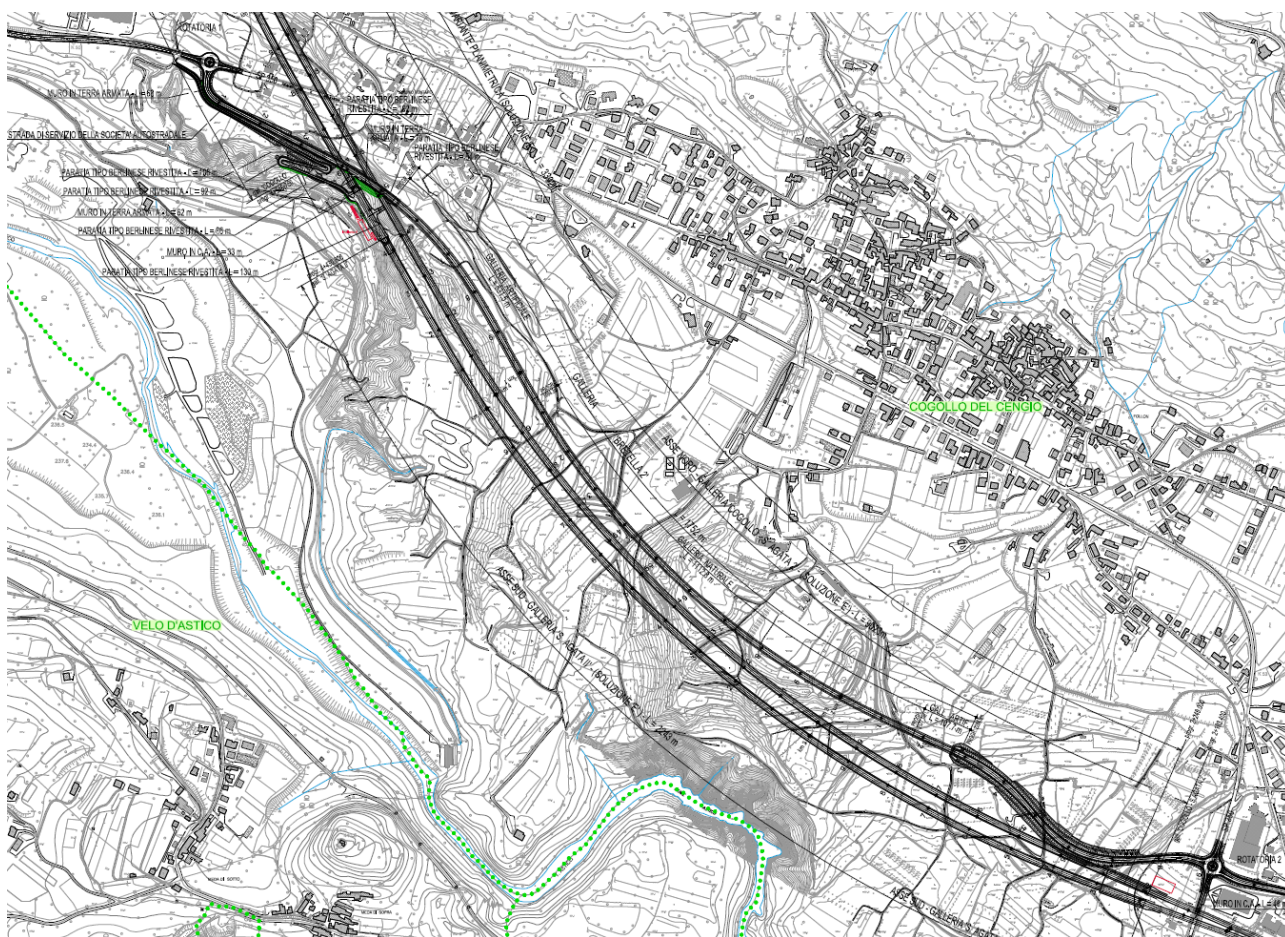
Planimetria Soluzione E nell'area di Cogollo del Cengio
